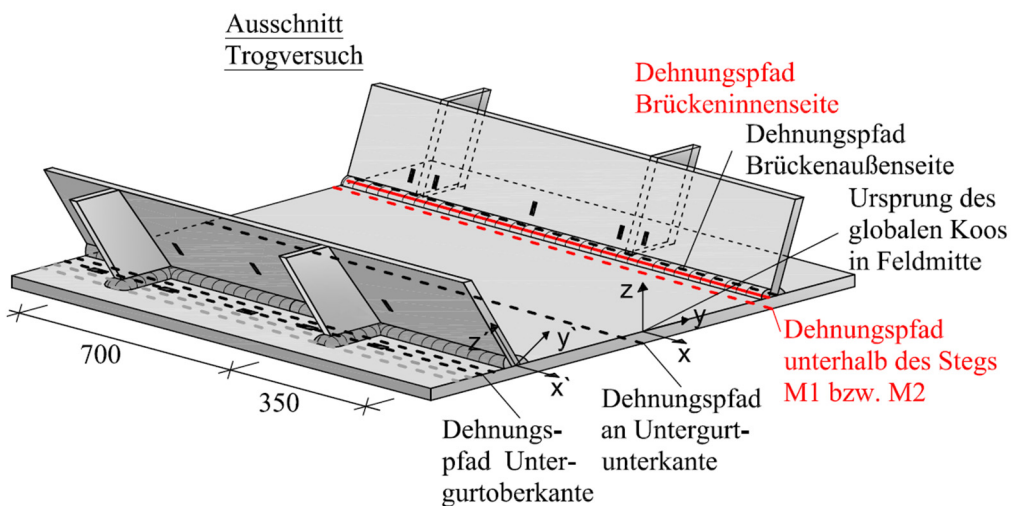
Darstellung der Pfade entlang der Brückenlängsachse an einem Ausschnitt ab Feldmitte
